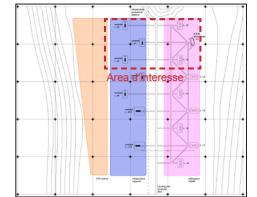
Vista volo d'uccello di una porzione di planimetria generale
